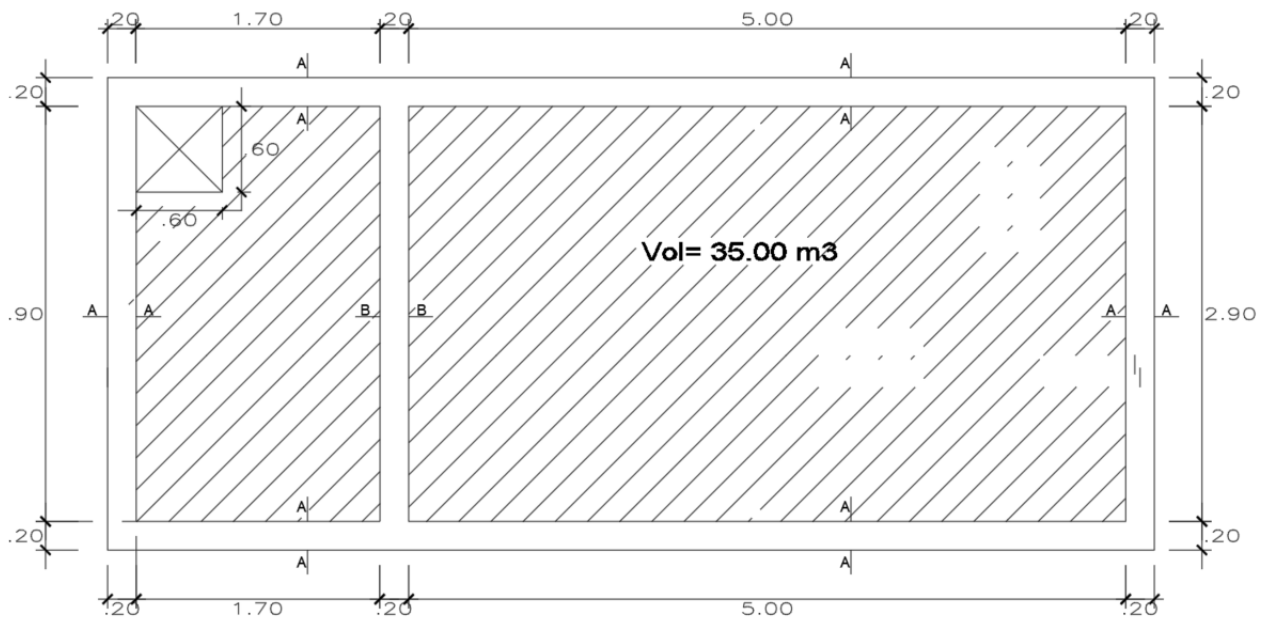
Vista en planta de distribución de cisterna y cuarto de bombas
